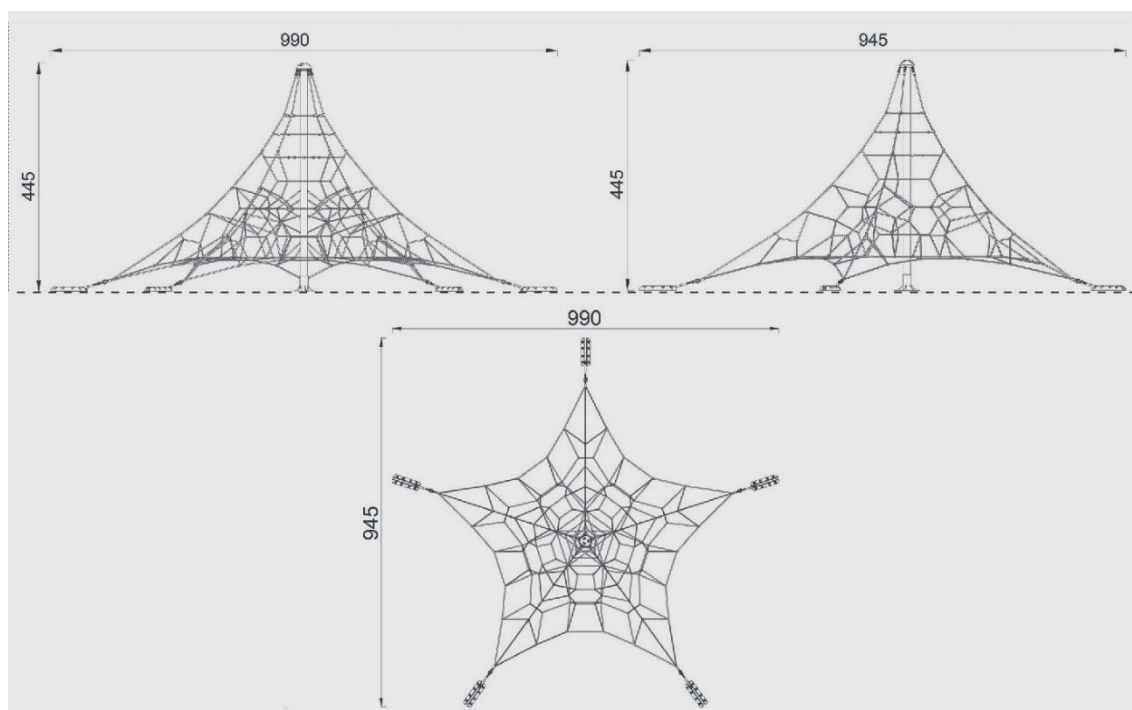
Estructura tridimensional, modelo redes A5. Fuente: Saludes Play
